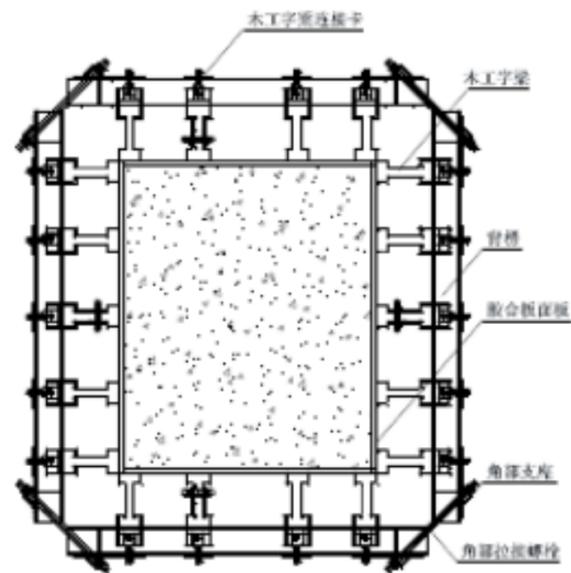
混凝土柱构件的铝梁木模板示意图
